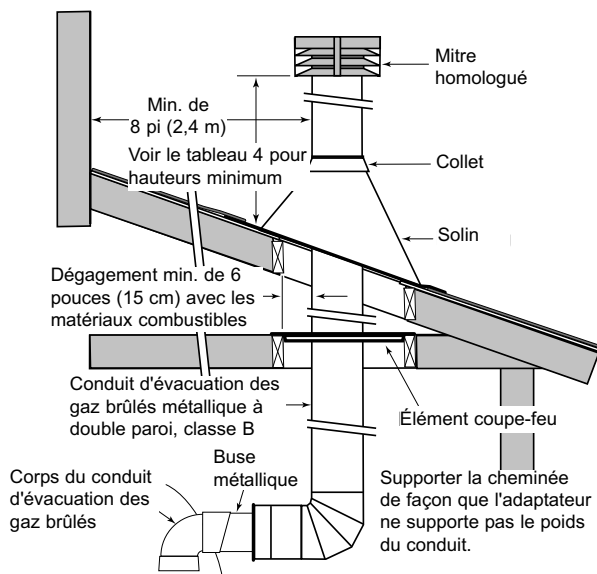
B : Installation type aux États-Unis du conduit vertical d'évacuation des gaz brûlés en métal (pression négative)
